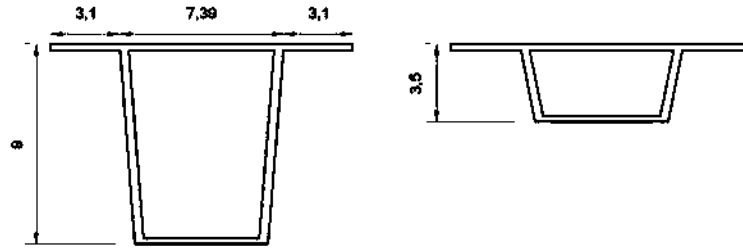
a Dimensiones de la sección transversal del puente voladizo balanceado (m).
